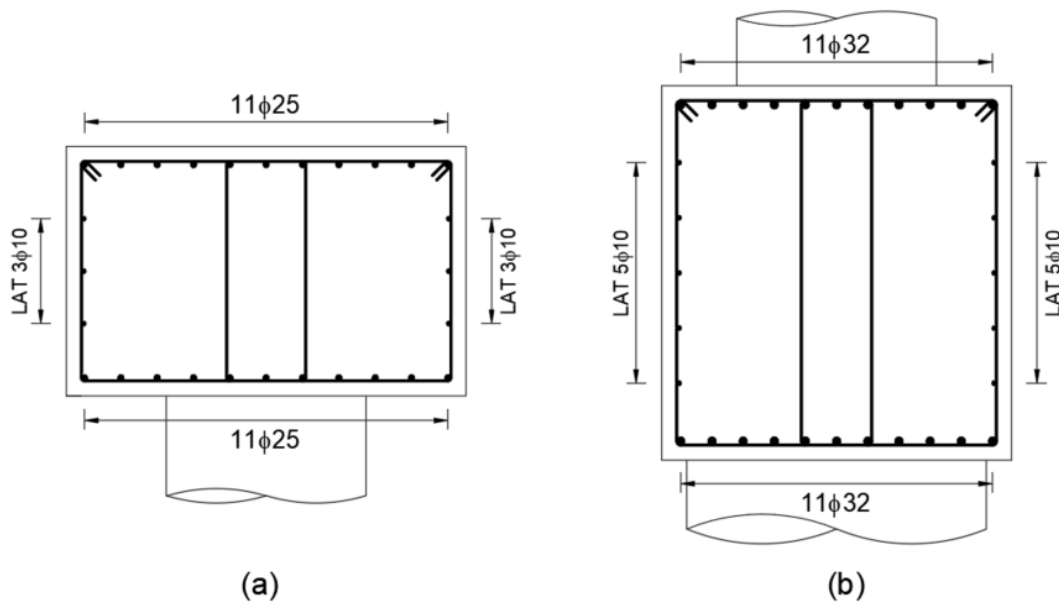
Sección transversal de vigas secundarias: (a) viga cabezal, (b) viga fundación.
